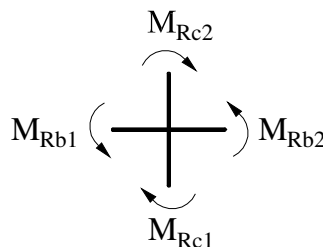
Echilibrul momentelor încovoietoare la un nod interior pentru o structură în cadre.
